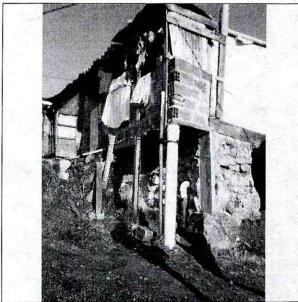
Vista de fachada del predio ubicado en la Calle 74 A Sur # 23-07
